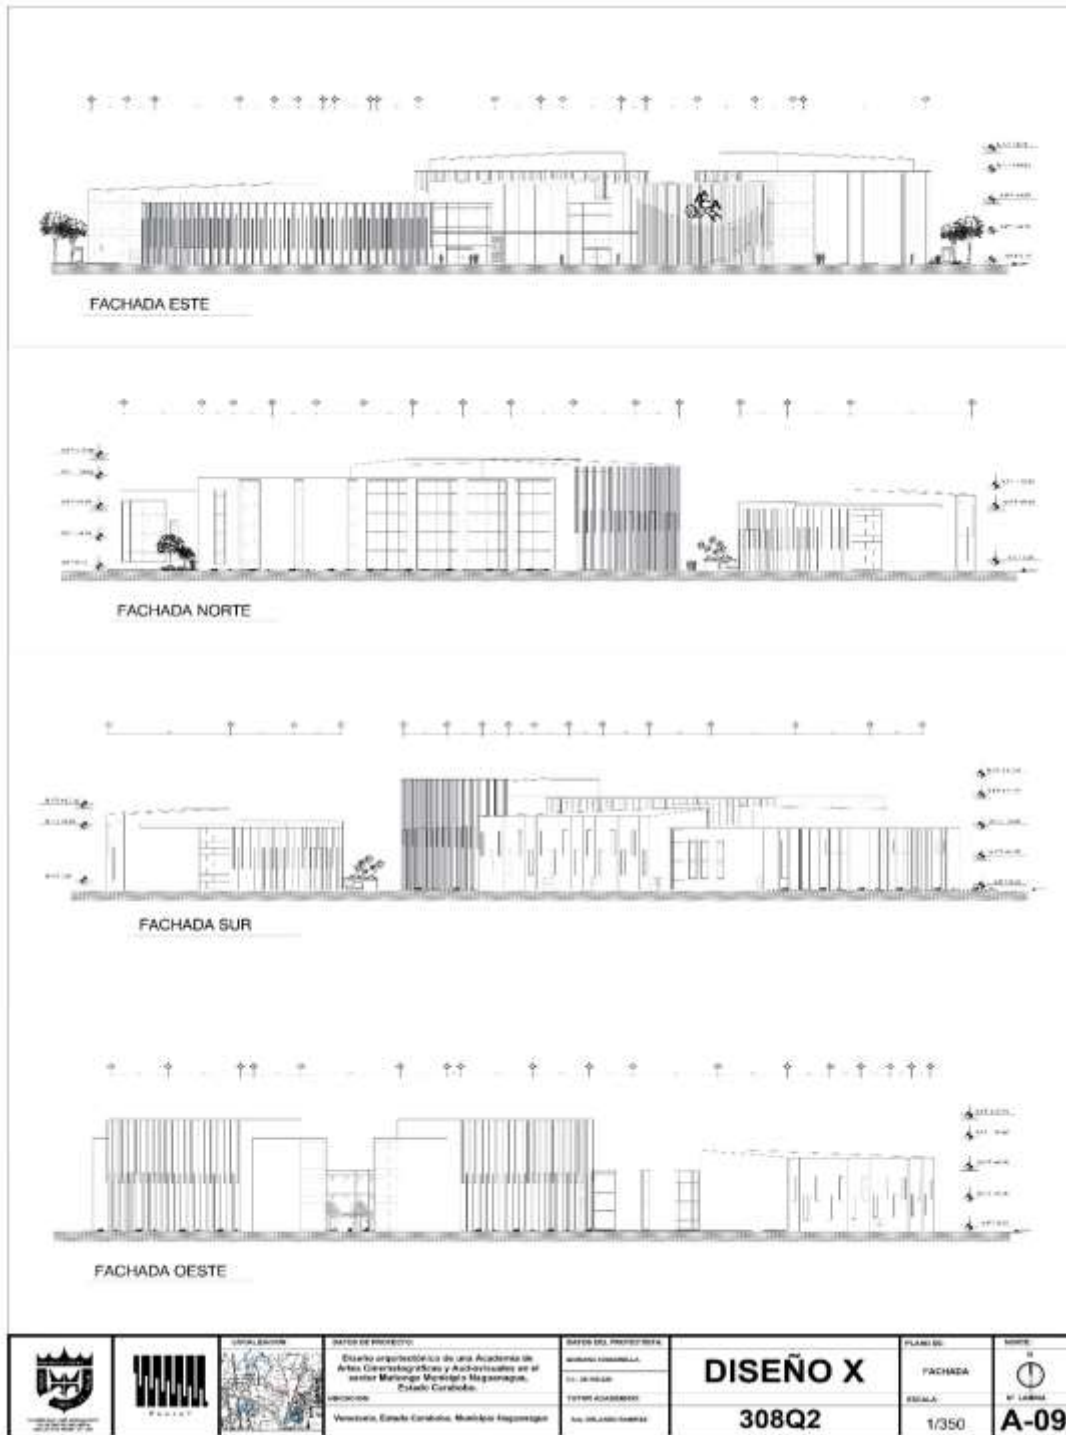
A-09 Fachadas de la Academia y el Cine. Norte y Sur. - Fachadas de la Academia Este y Oeste Fuente: La Autora (2022)
